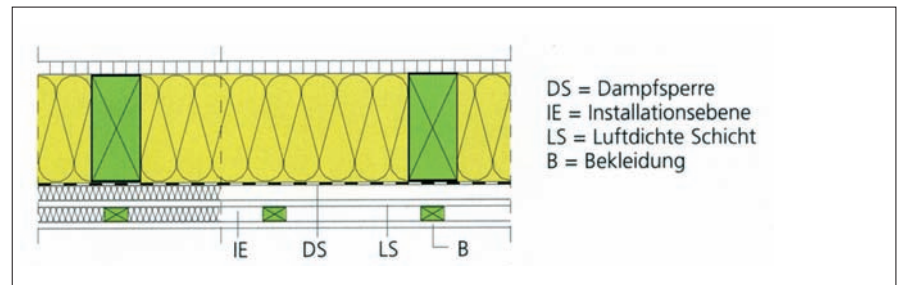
Decke ohne obere Dämmstoffauflage und zusätzlicher unterer Installationsebene
